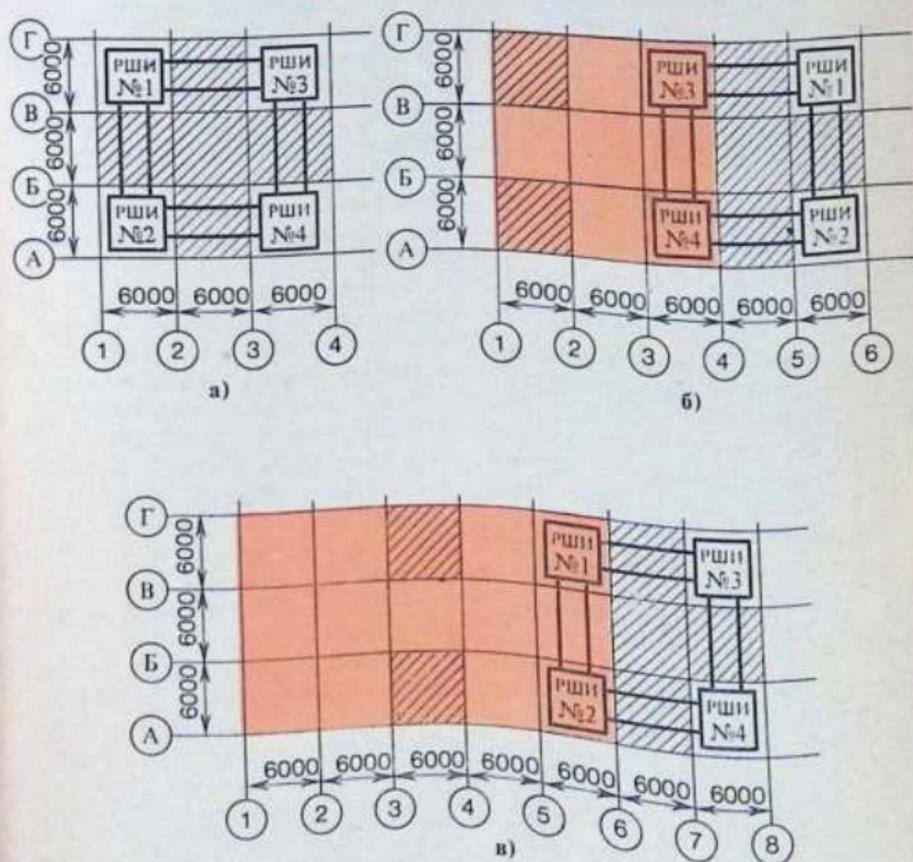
Схема последовательности установки РШИ при монтаже каркаса здания:
